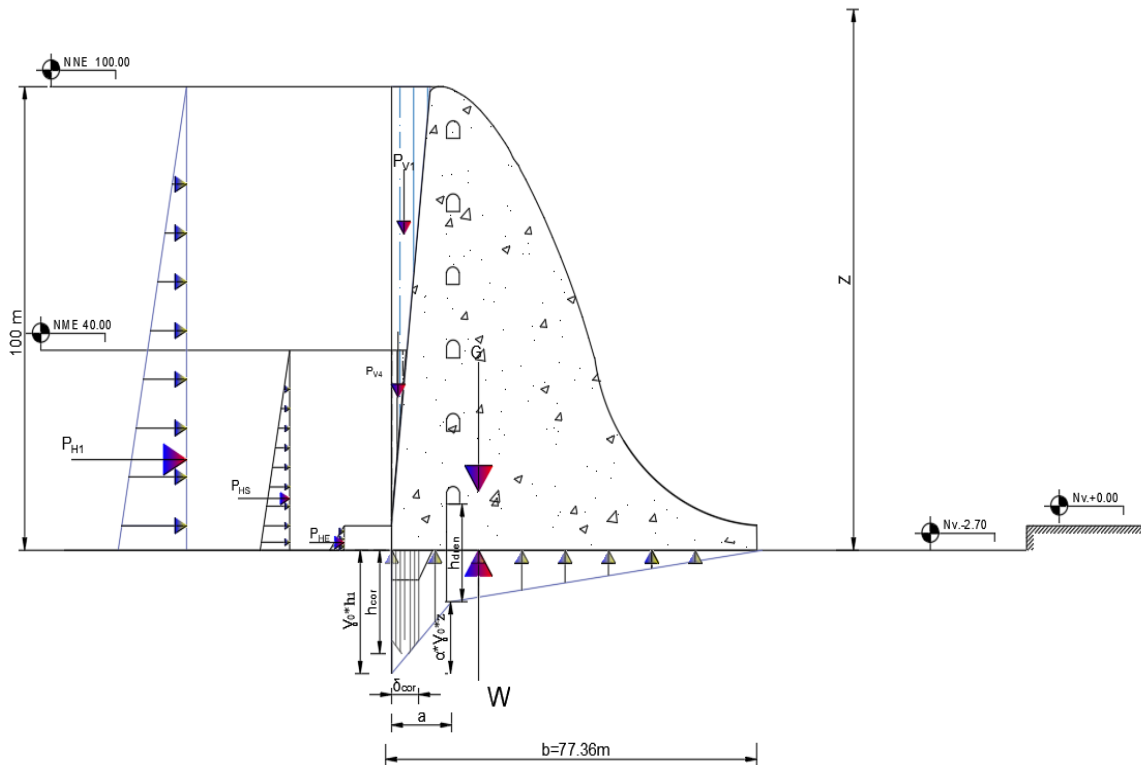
Fuerzas actuantes para el cálculo del perfil constructivo de la presa de HVC
